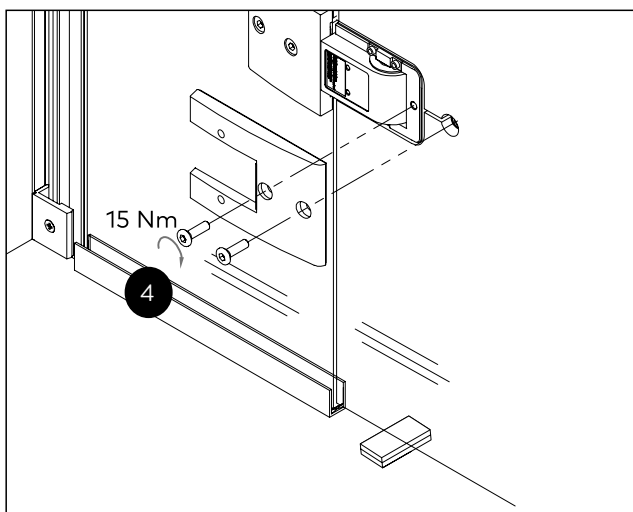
Installation du vantail de la porte en verre à la paumelle à rappel
